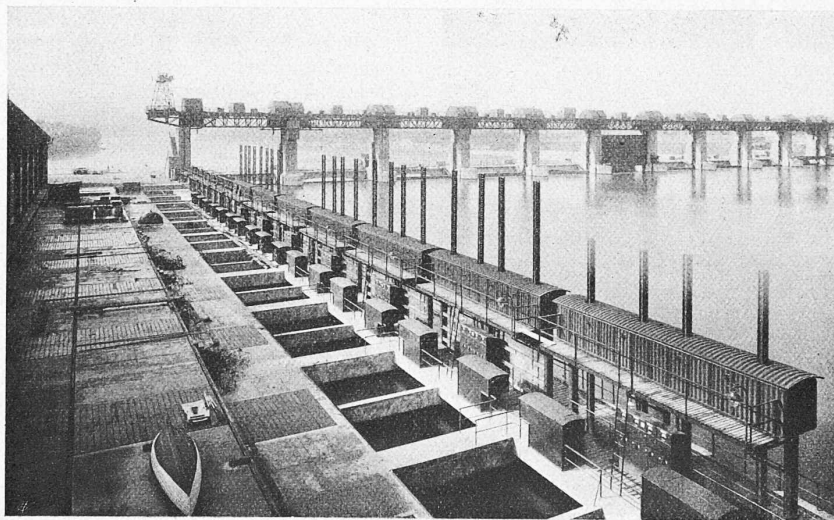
Blick vom Bockkran auf die Turbinenkammern und Einlaufwindwerke.
